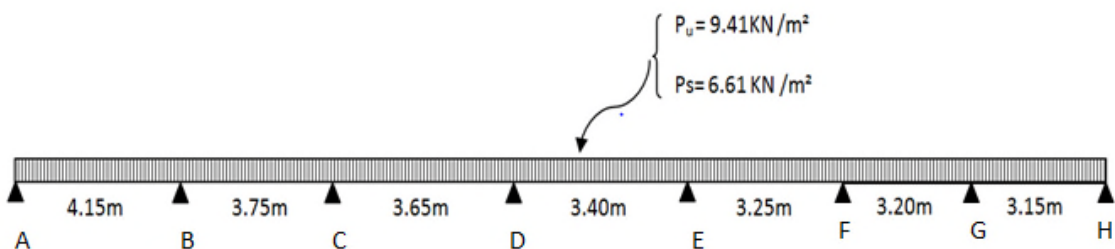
charges appliquées sur la poutrelle type 1 du plancher s-sol
